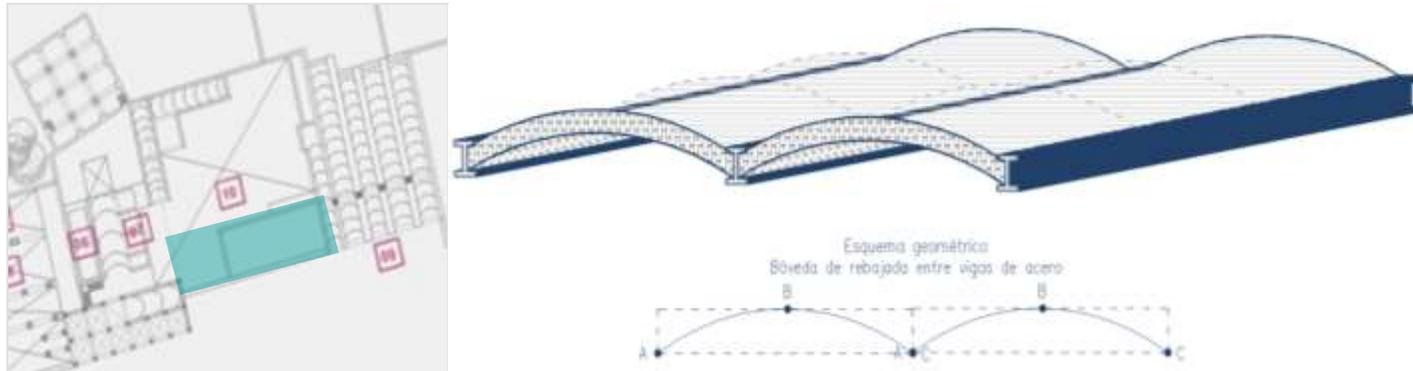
Tipología de bóvedas rebajadas o catalanas de mampostería de tabiquería
